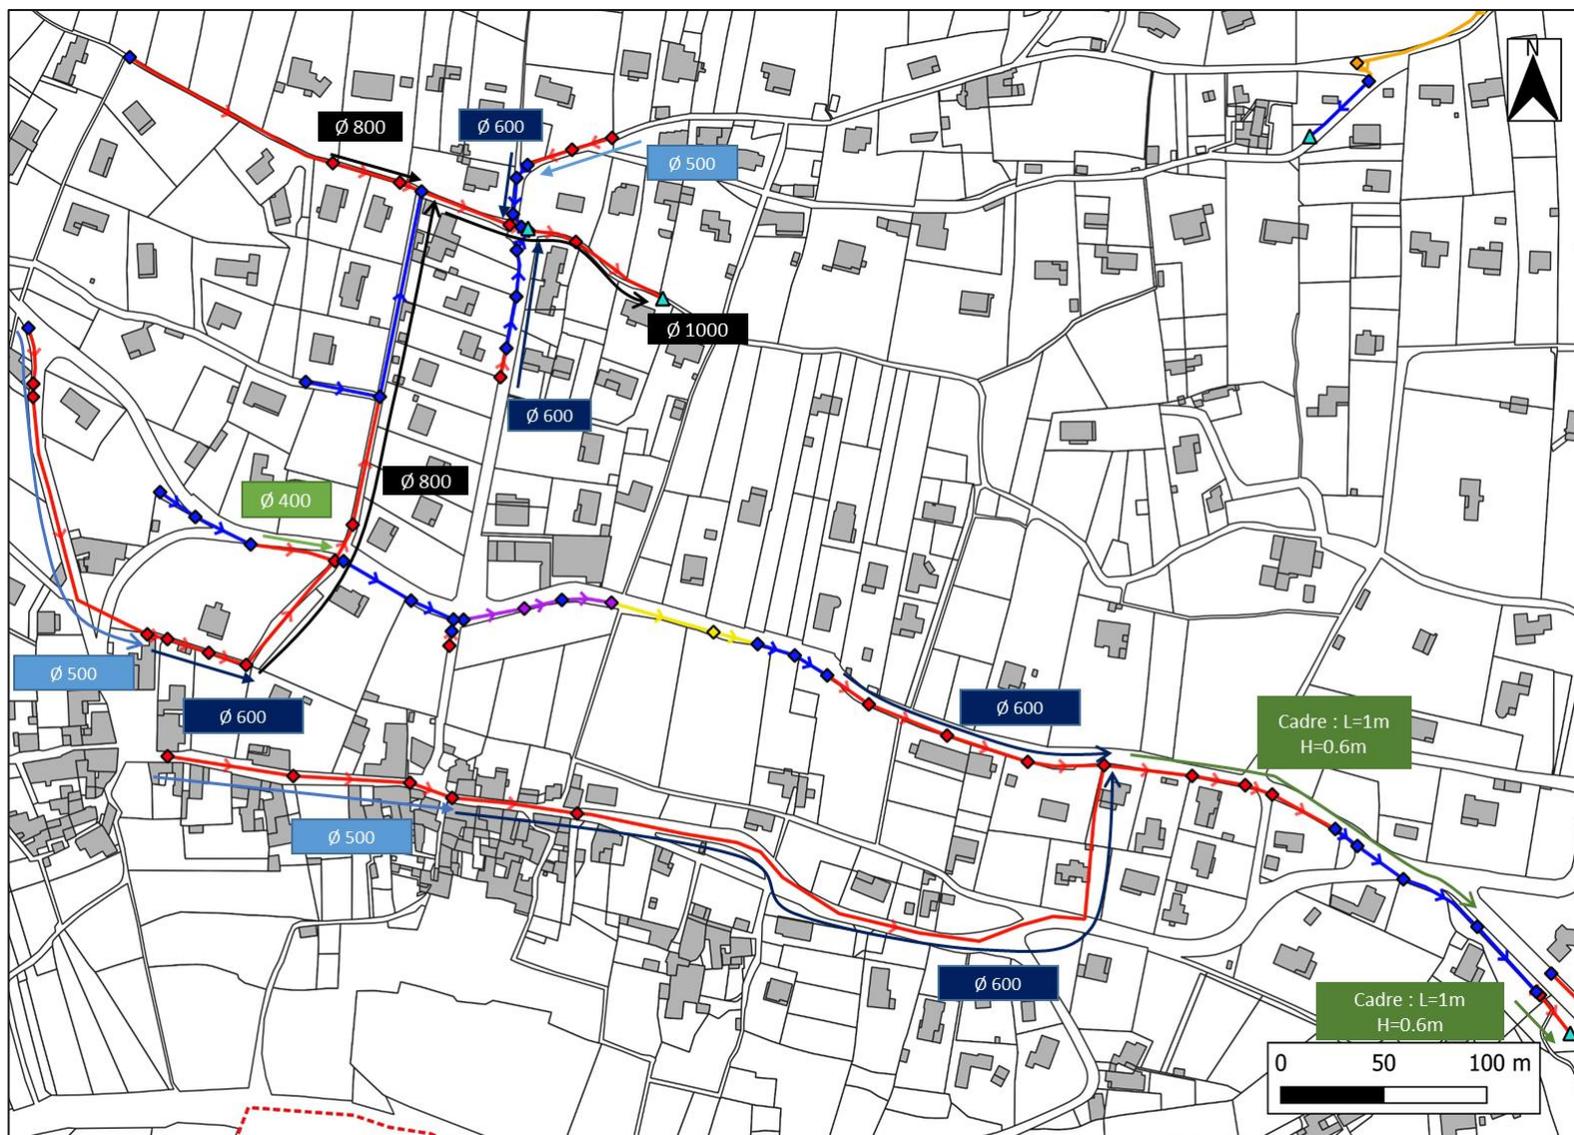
Proposition d'aménagement secteur Branoux (Ouest)
